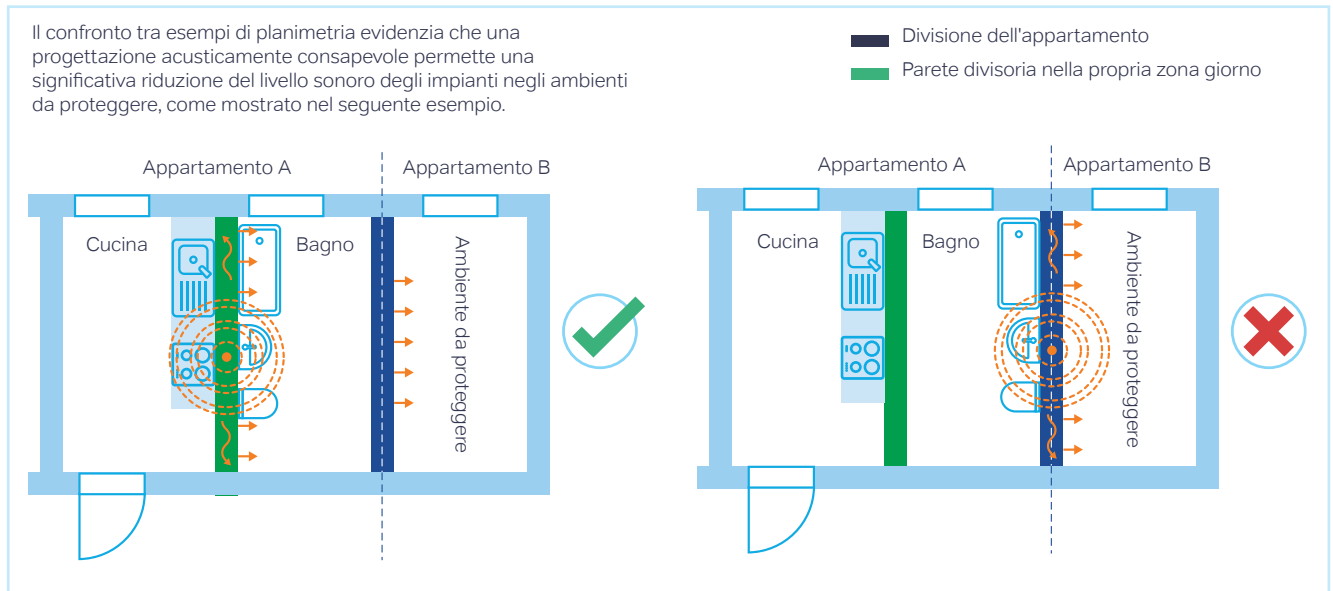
Una planimetria favorevole dal punto di vista dell'acustica edilizia
